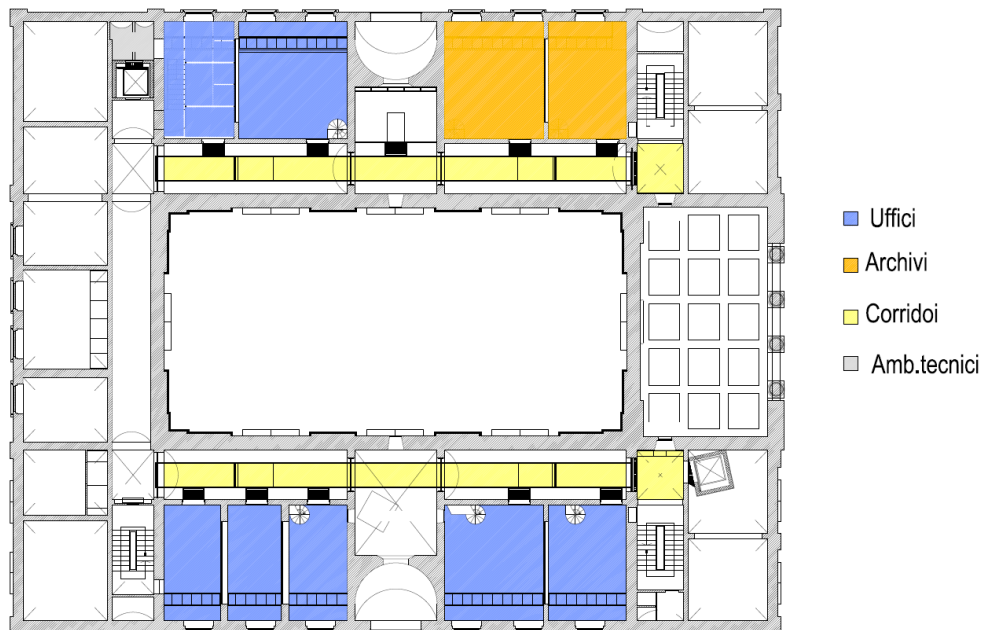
Planimetria del piano ammezzato con indicazione degli ambienti a quota 4 m
